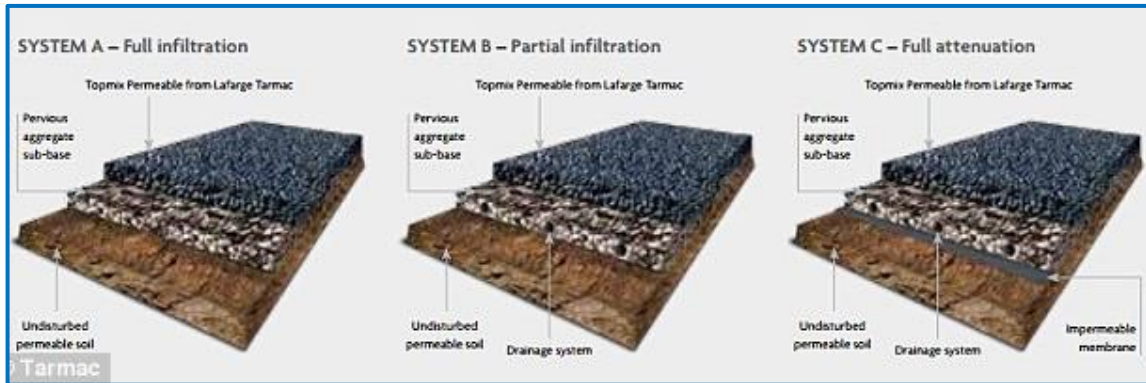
Sistemas de Infiltración en Concreto Permeable. Sé diseñó para Sistema A – Full Infiltration
